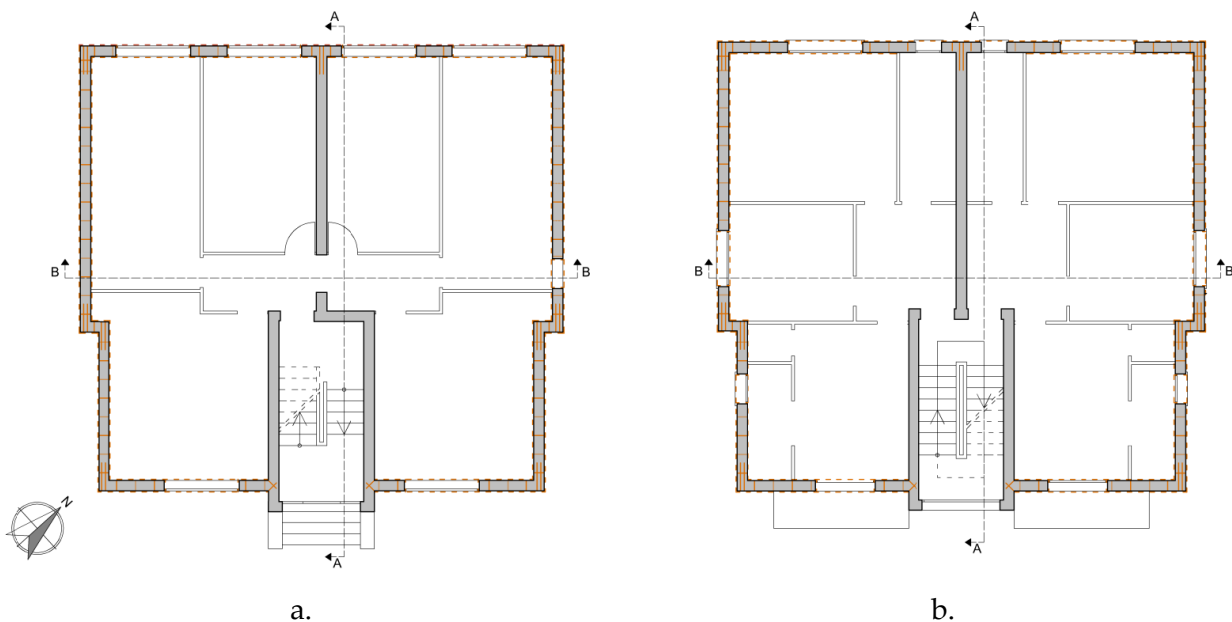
Intonaco armato con rete FRCM su due lati: a) pianta piano terra; b) pianta interpiano.
